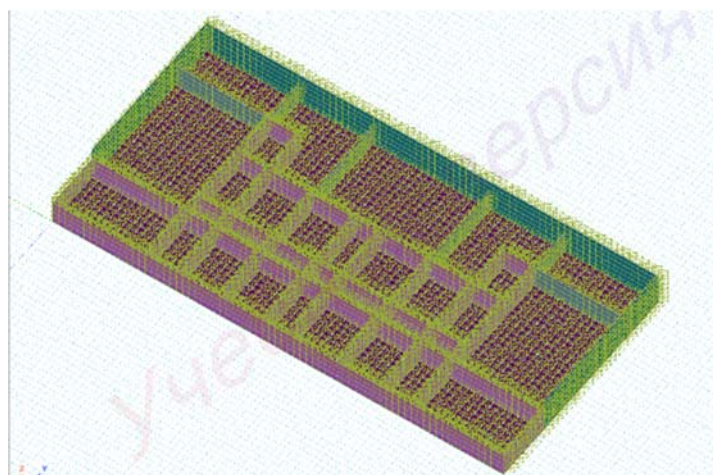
Модель фундаментной плиты с нагрузками от вышележащих конструкций в ПК Лира 10.6
